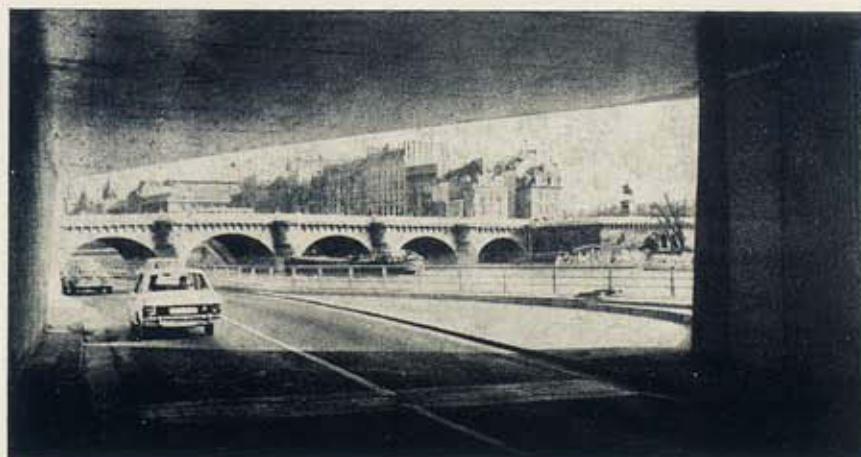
Voie express rive droite — la sortie du tunnel du Louvre sur la voie sur berge
